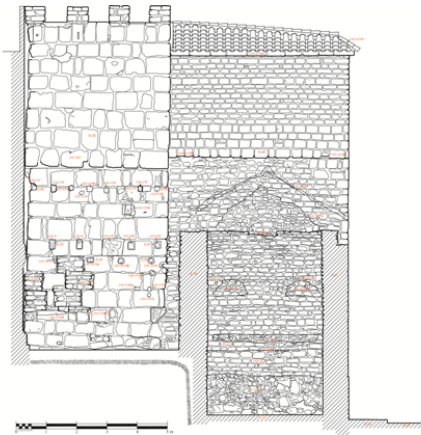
Alzado torre del Castillo. 2009. ARQVIPO.
